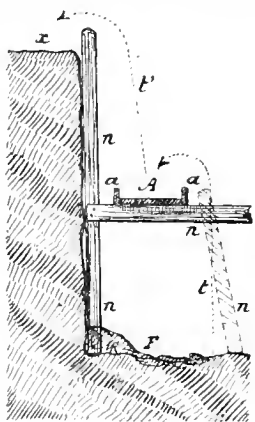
Coupe verticale d'une banquette pour l'élevation des terres.
